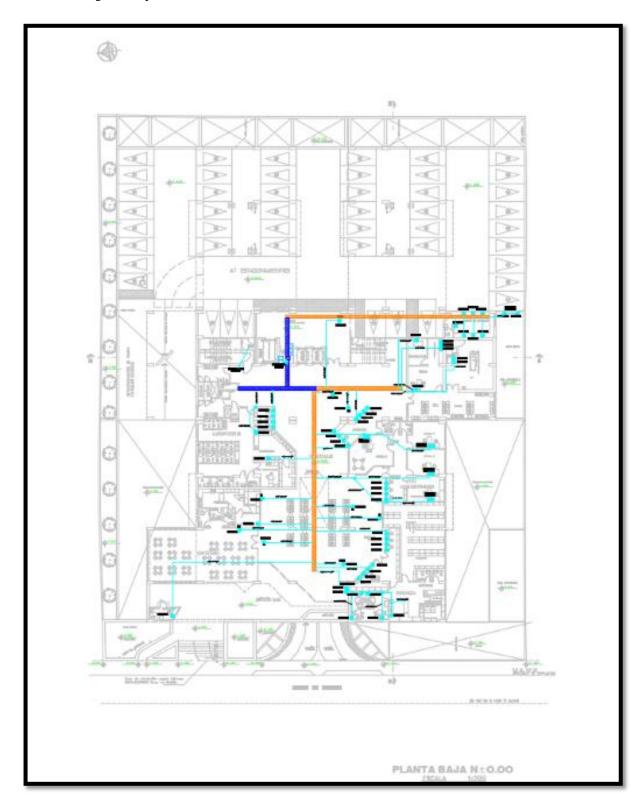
Plano Primer Piso implementado el cableado estructurado. Elaborado por: Bryan Córdova
